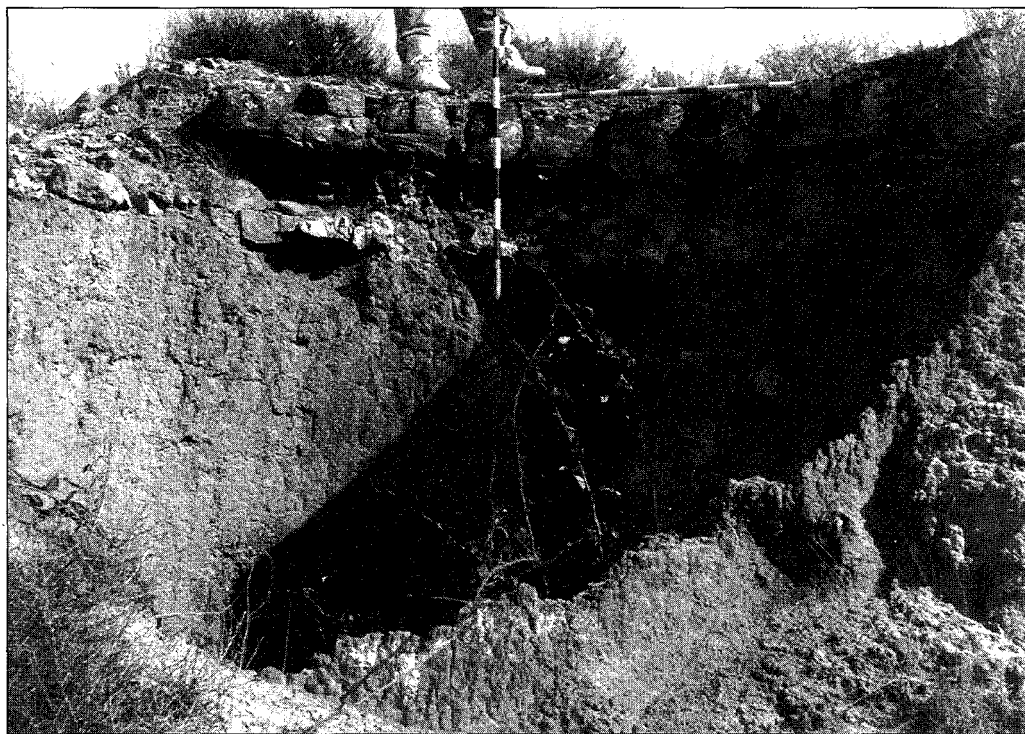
Calzada rota para construir un puente en *Barbarés*.
